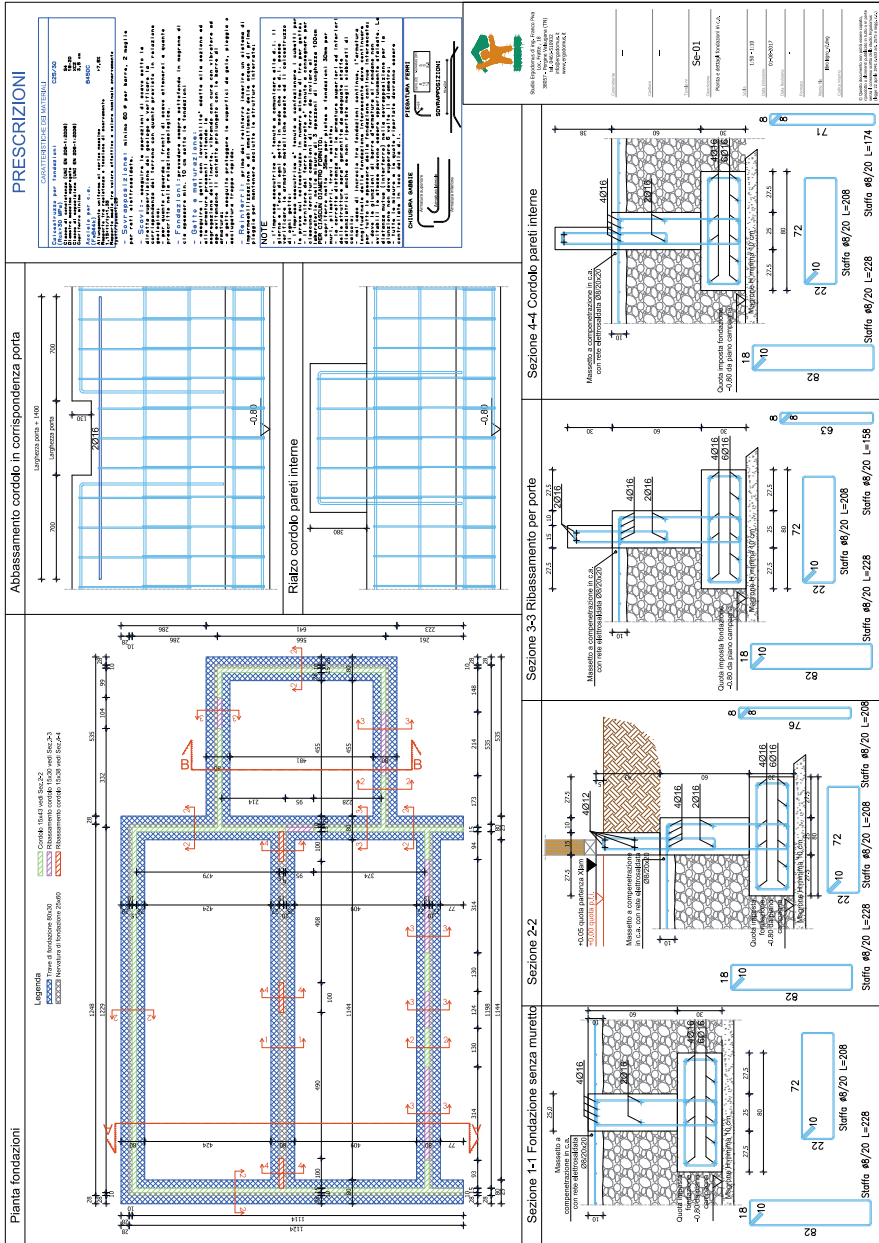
Pianta e dettagli di una fondazione in c.a.
